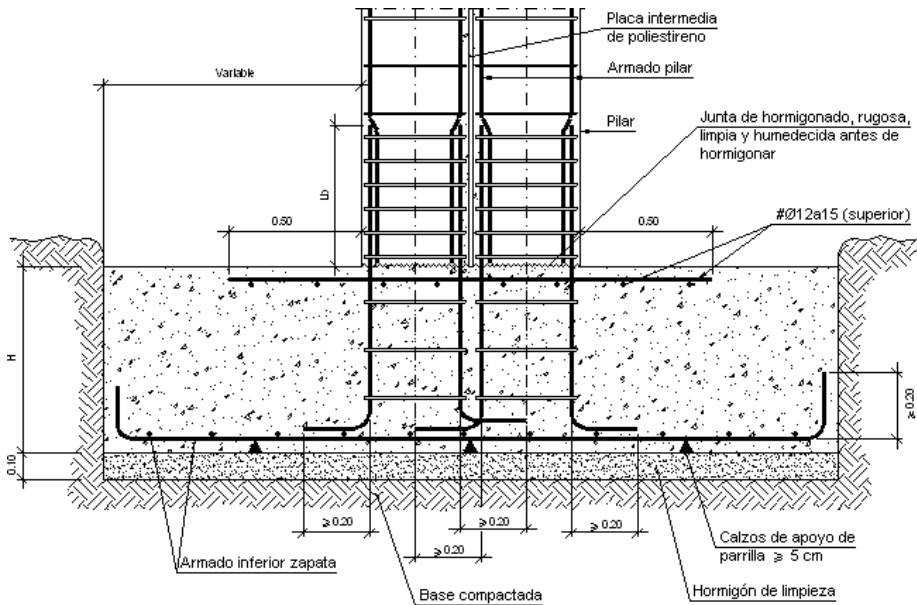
Zapata en diapasón. Imagen cortesía de CYPE, Biblioteca de detalles constructivos, Regalado et al., (2004).
